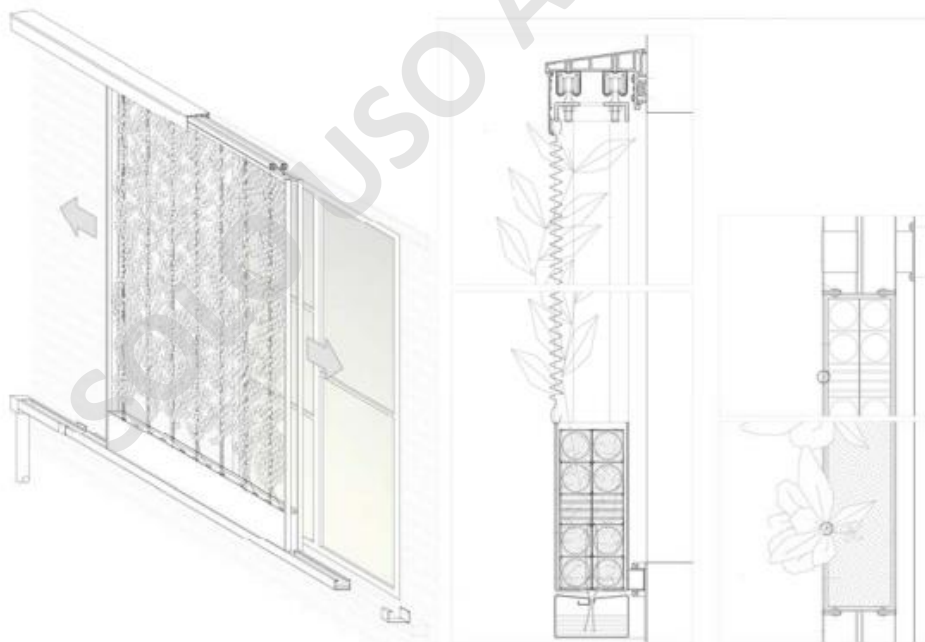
Detalle constructivo 2 fachadas deslizantes
